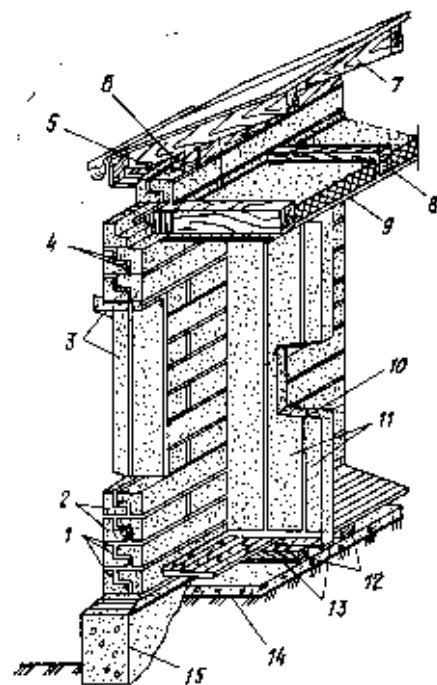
Деталь конструкции дома из мелкоштучных стеновых изделий
